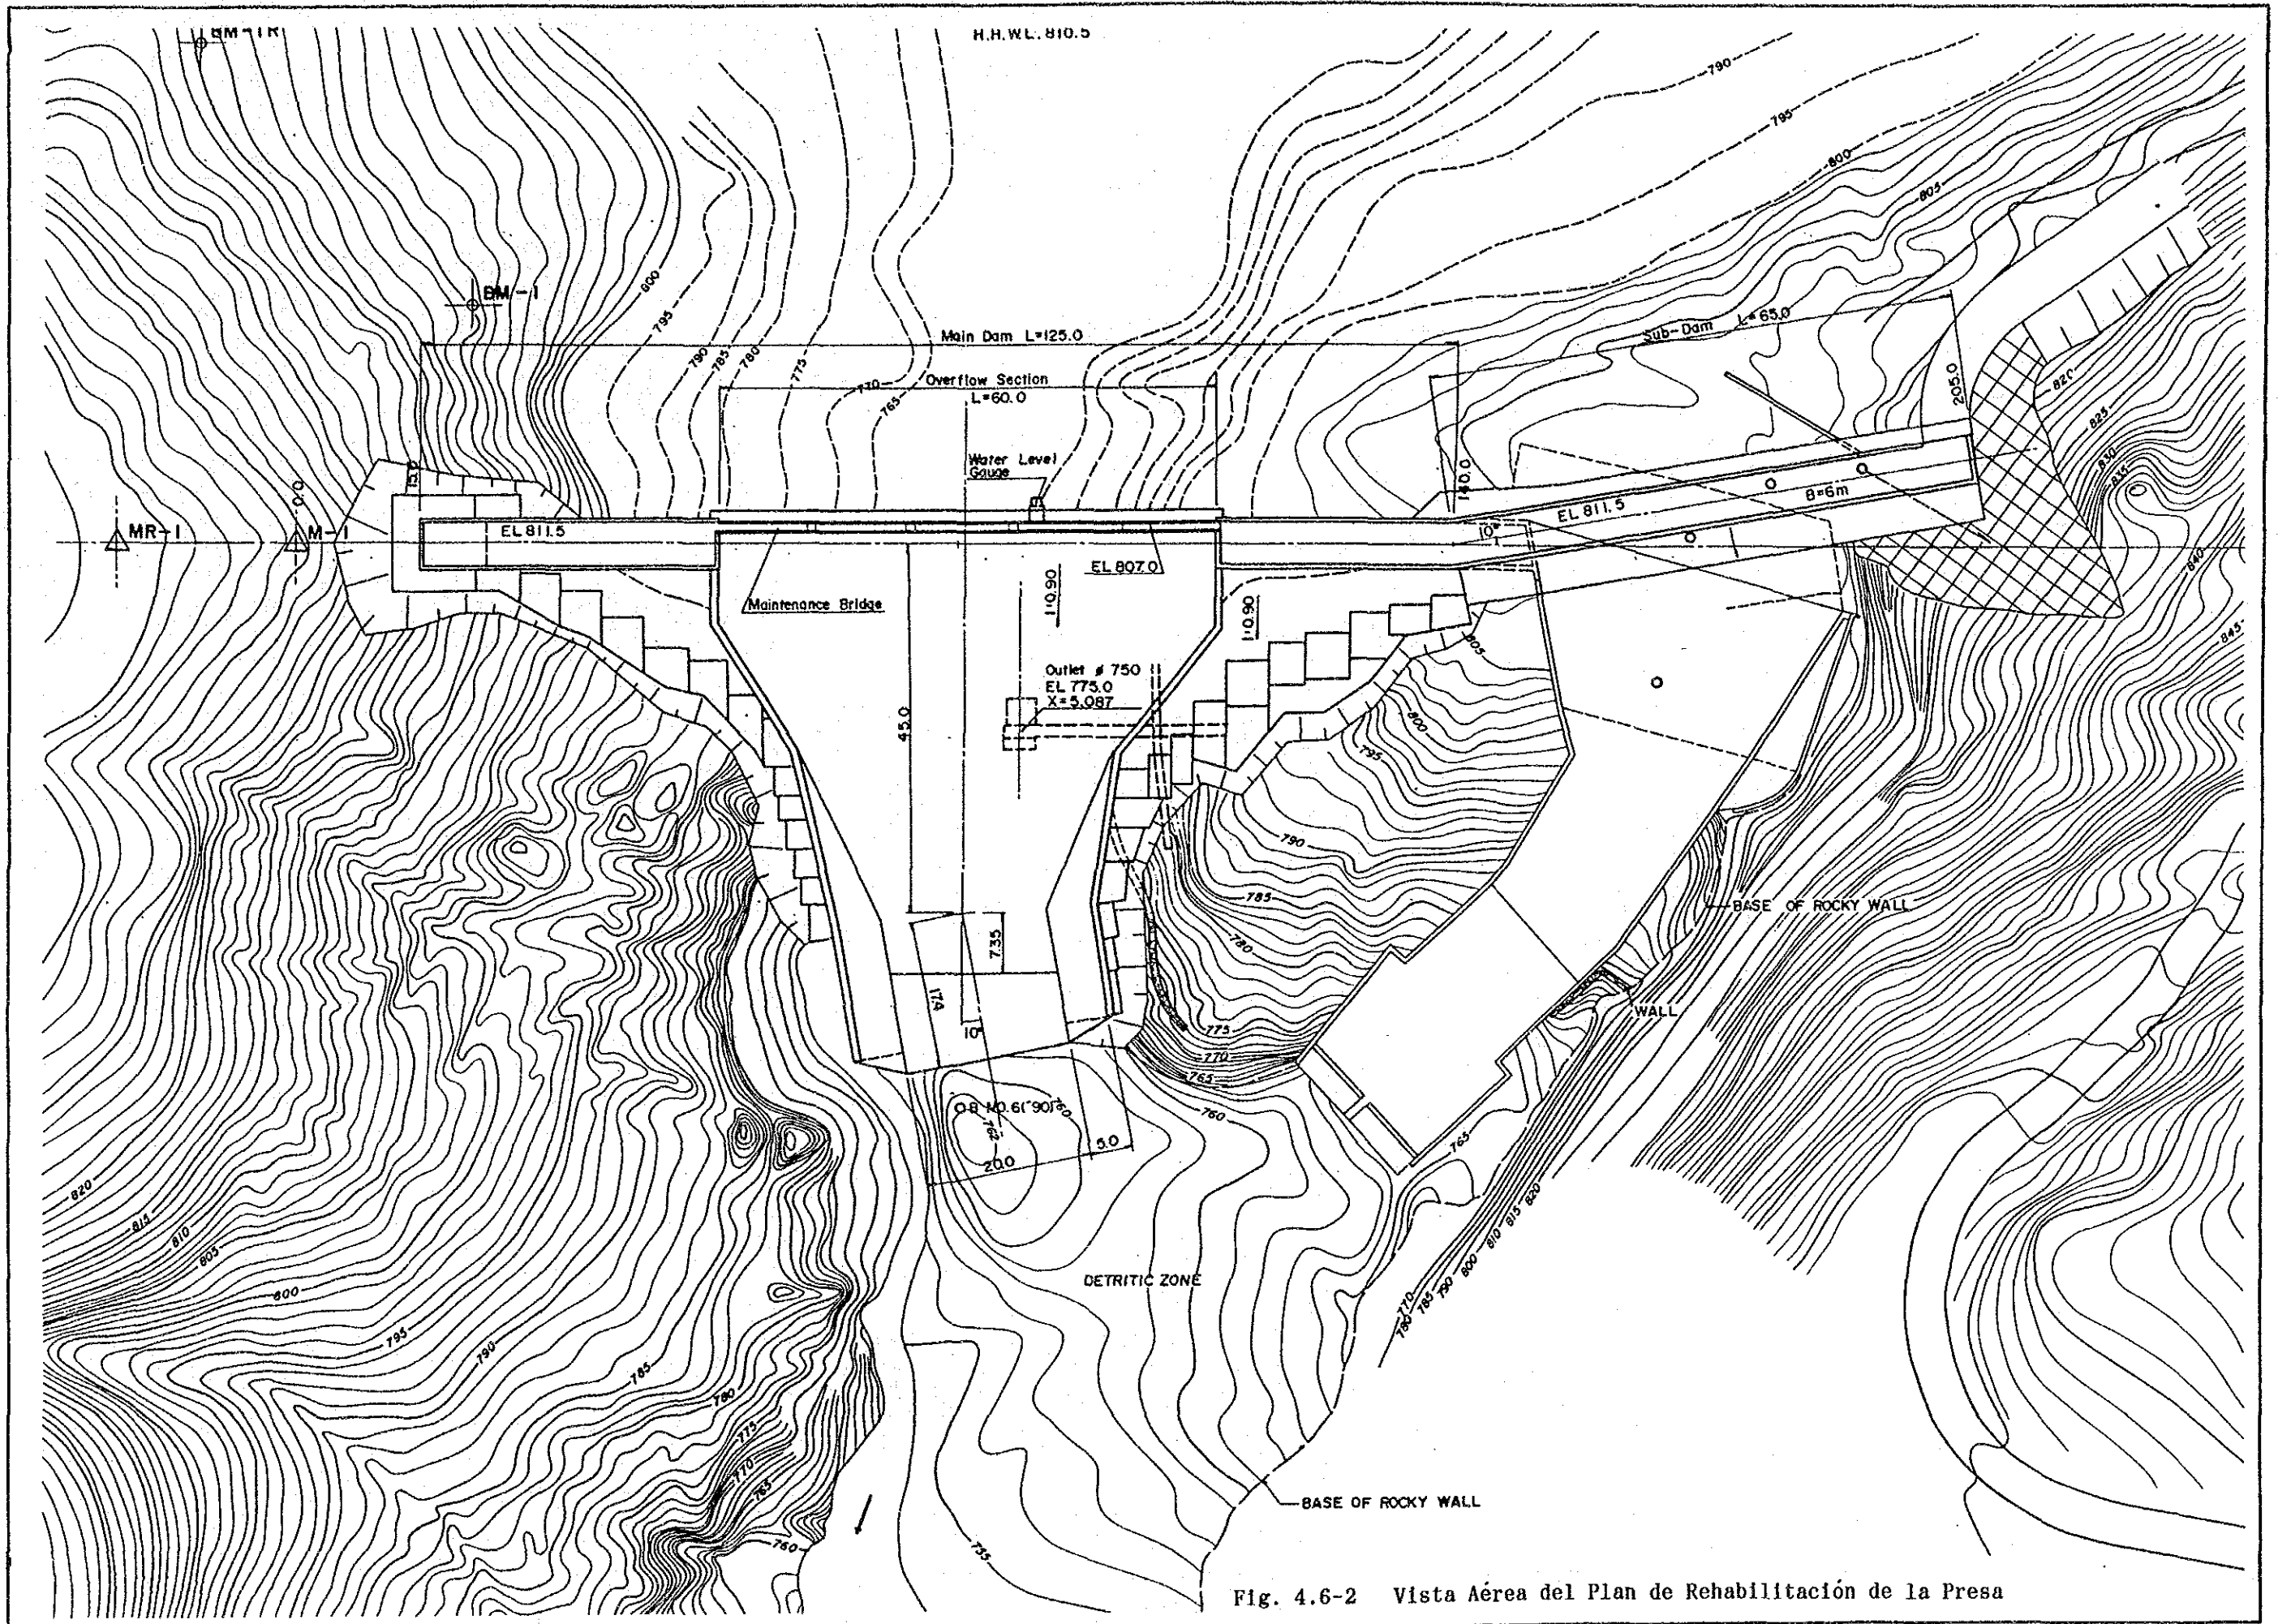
Vista Aérea del Plan de Rehabilitación de la Presa
